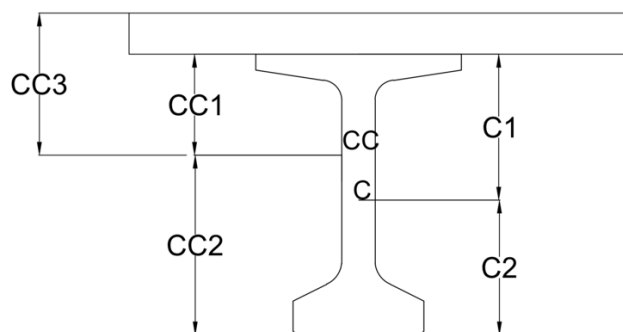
Distancia al centroide de la viga y a la sección compuesta.
